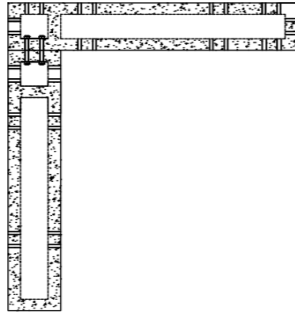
11 sambungan Balok dengan Kolom lantai Atap tipe 1
